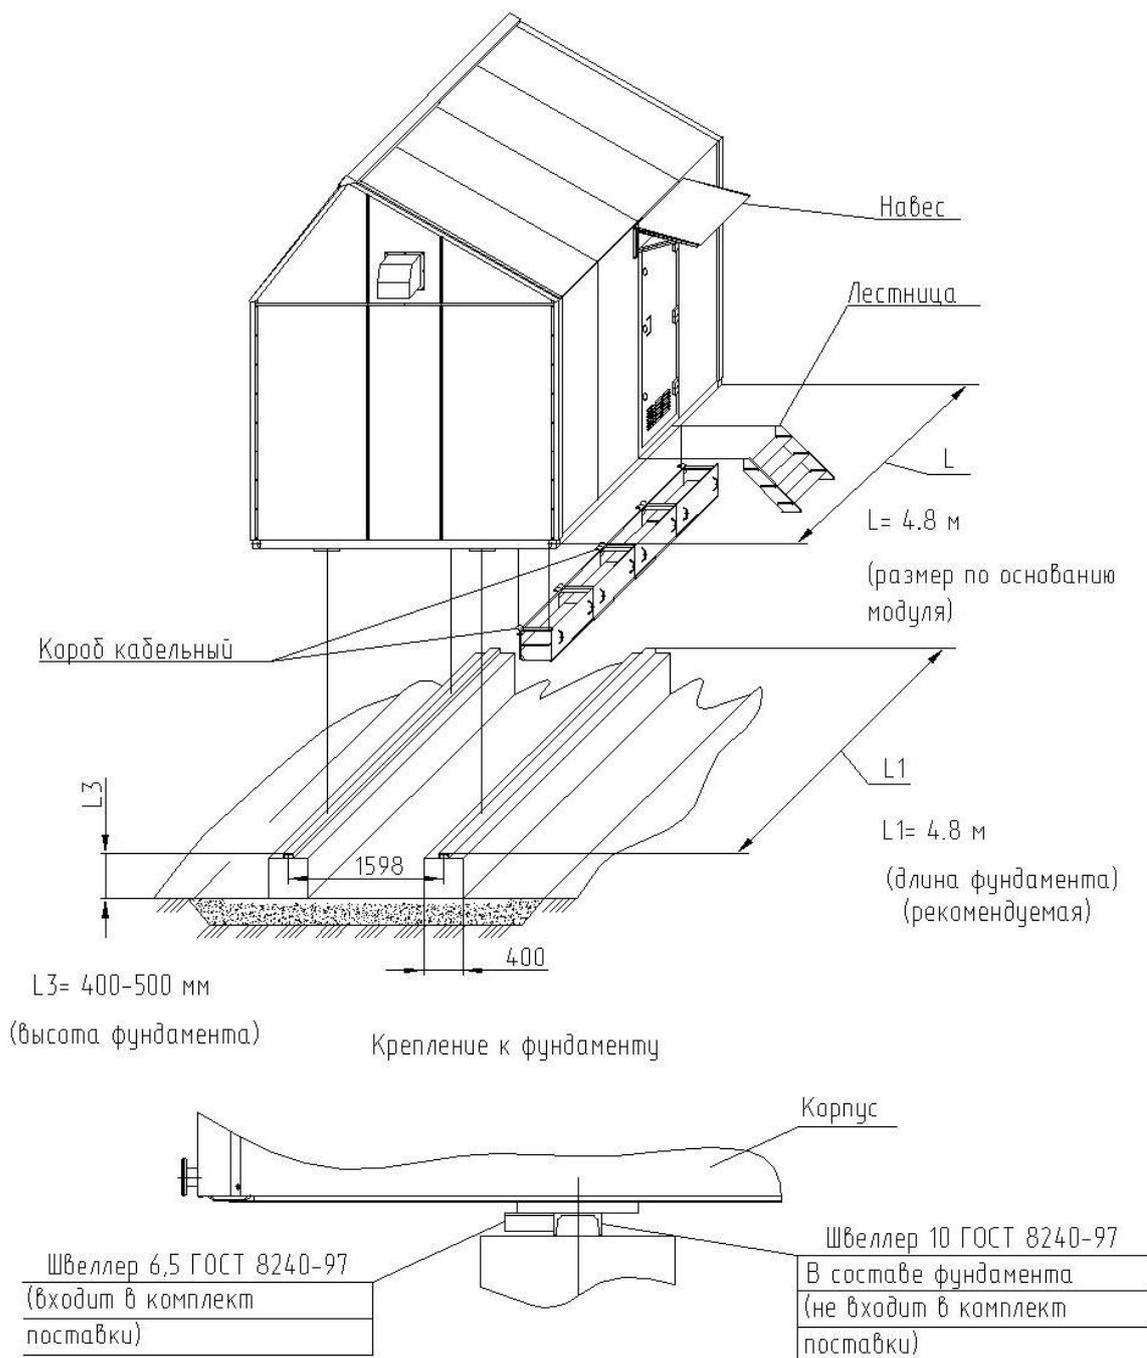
Установка модуля на бетонный ленточный фундамент
